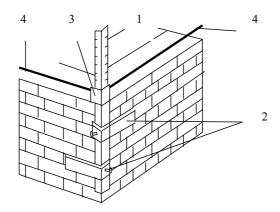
Схема крепления угловой металлической порядовки: 1 — порядовка; 2 — скобы для крепления порядовки; 3 — ползунок для крепления причалки; 4 — шнур-причалка
